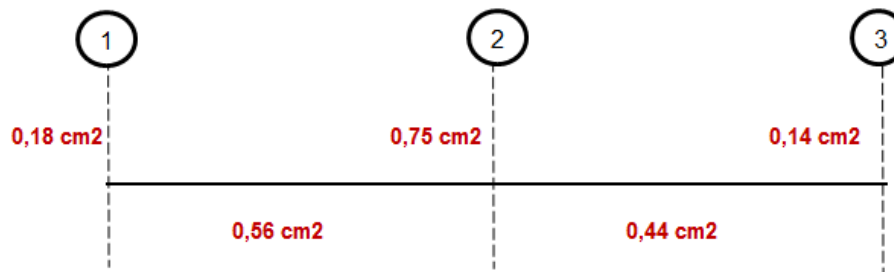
ÁREAS DE ACERO LONGITUDINAL REQUERIDAS EN LOSAS (DIRECCION X-X, Y-Y) – DUAL TIPO I
